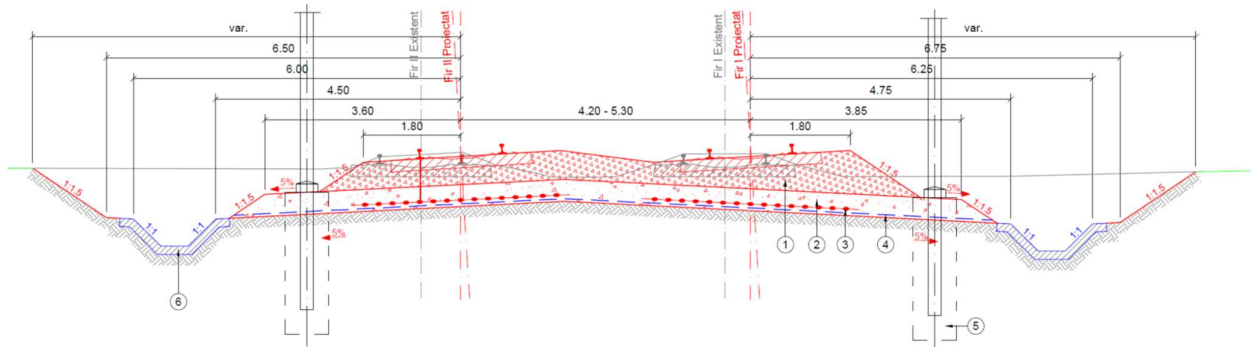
Profil transversal tip în debleu cu șanțuri din beton
